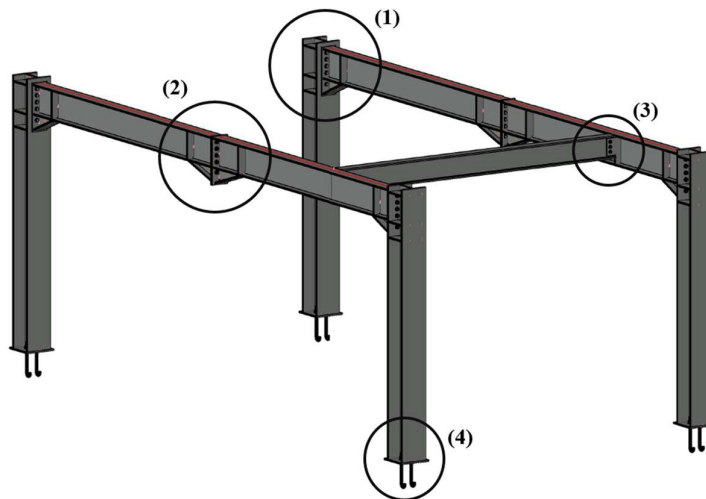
Ligações aparafusadas estudadas: (1) Ligação viga-coluna com chapa de extremidade; (2) Ligação viga-viga com chapa de extremidade; (3) Ligação viga-viga com chapa de *gousset*; (4) Base de coluna.
